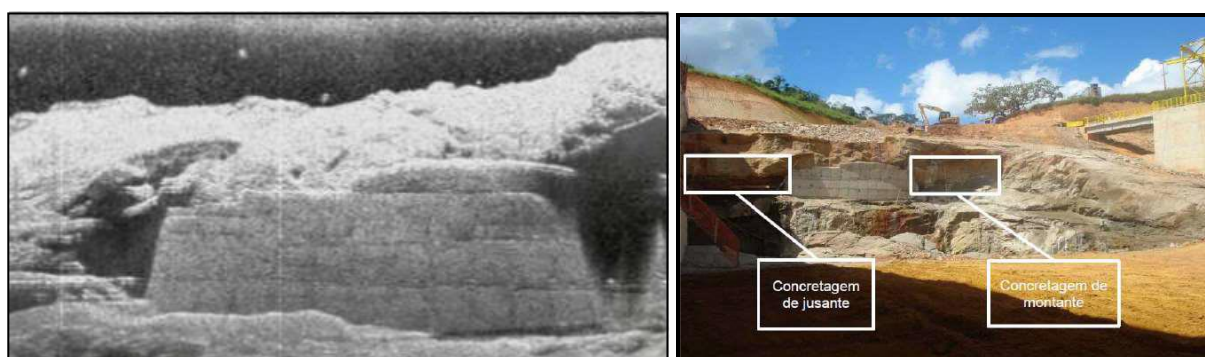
Imageamento subaquático SeeSub® e localização das concretagens submersas de 2021
